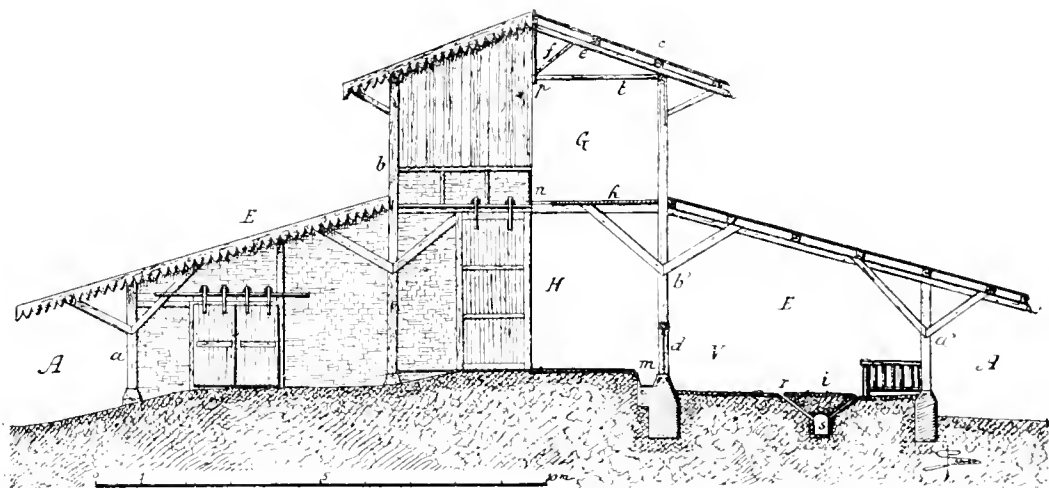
Élévation et coupe de la vacherie de Forges.
